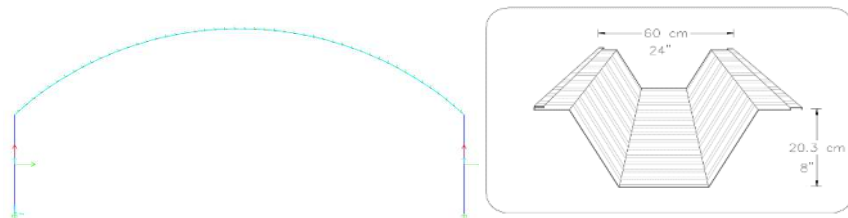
Cobertura atosoportada – Vista Sección y elevación
